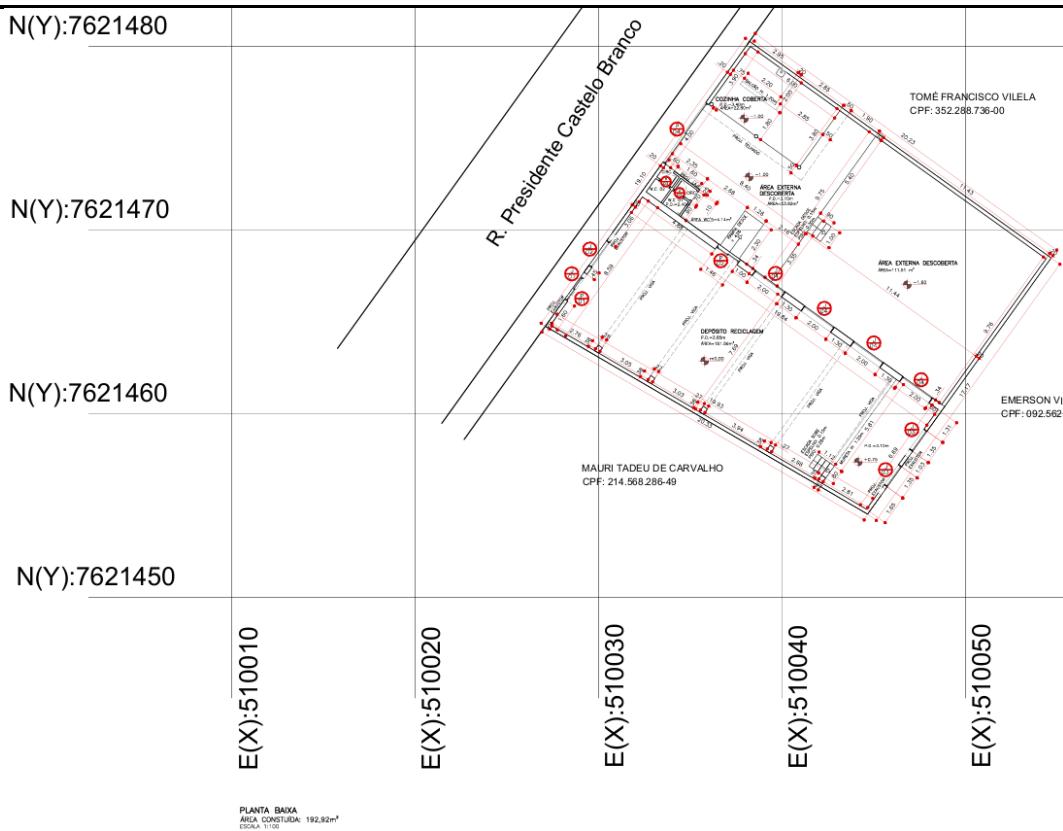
Planta baixa da ASCALURE. Fonte: RAS.
